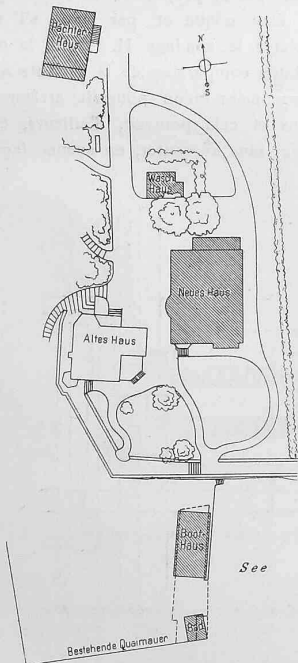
Lageplan des Landhauses «zum Flühli». — 1:1200.
